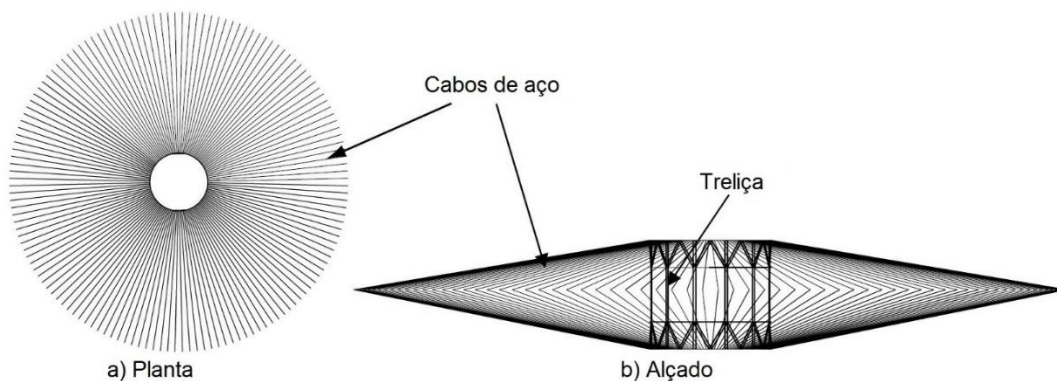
Esquema estrutural do pavilhão desportivo em Pequim (adaptado de [25])
